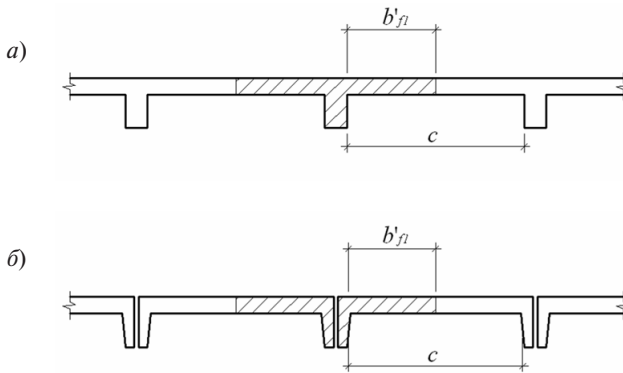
Тавровое сечение в составе монолитного ребристого перекрытия (а) и тавровое сечение в составе сборного панельного перекрытия (б)
